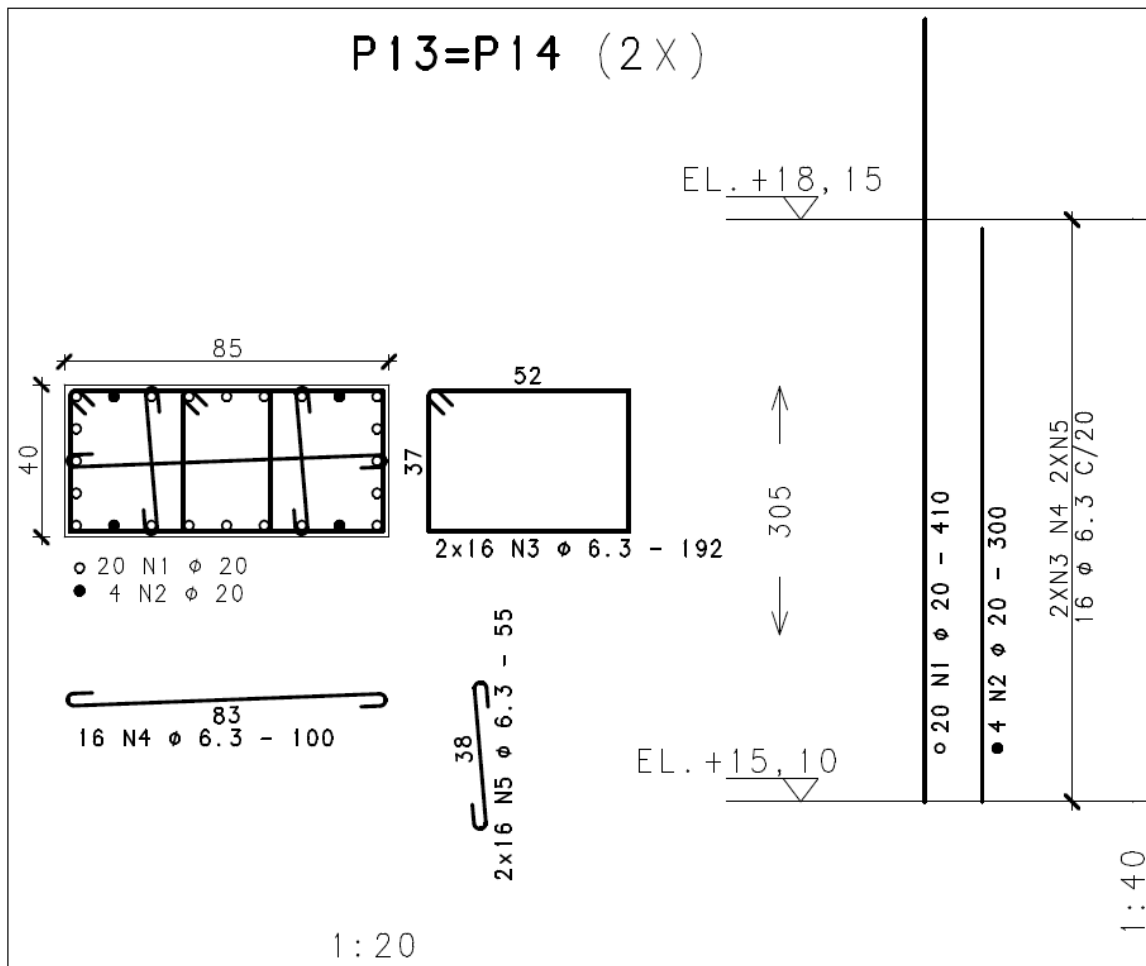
Desenho de armadura dos pilares P13 e P14, em um lance do pavimento tipo.
